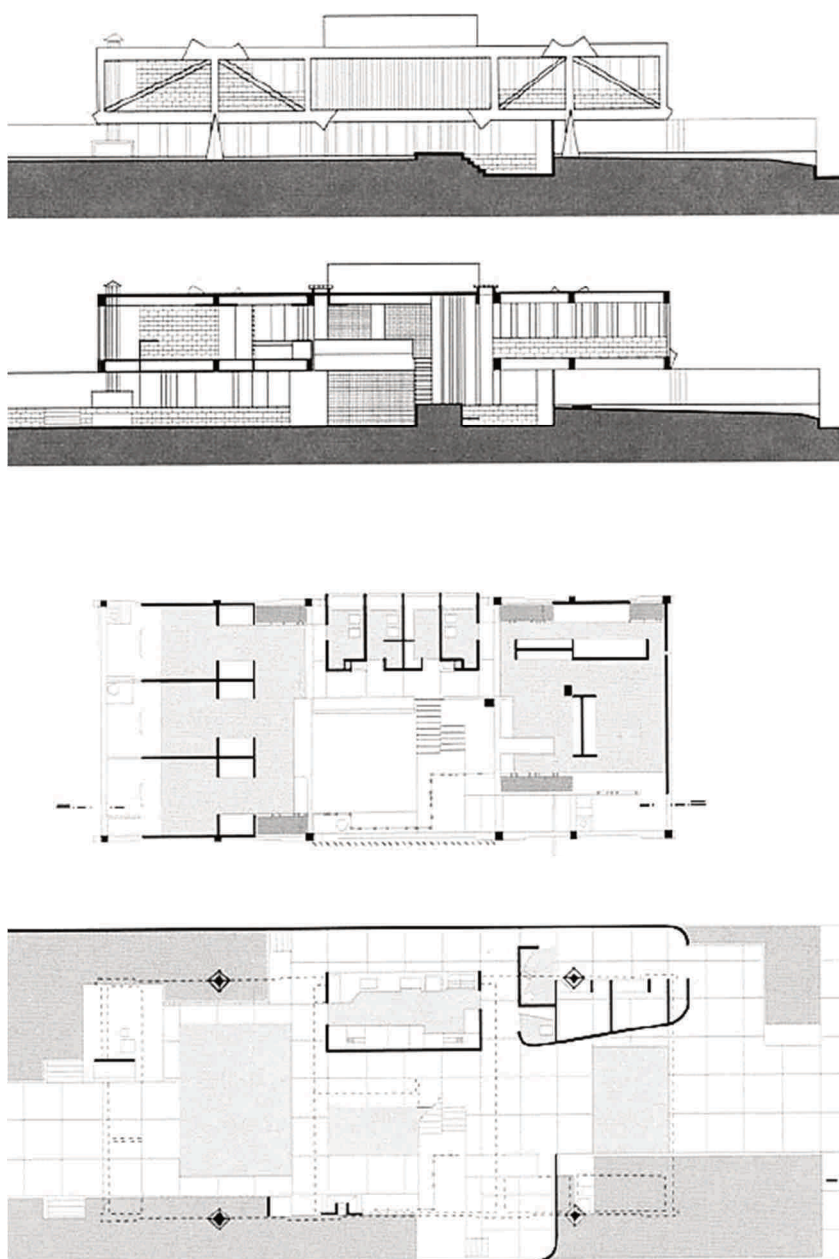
Elevação lateral, secção longitudinal, planta do pavimento superior e planta do pavimento térreo da residência Cleômenes Dias Batista. Como pode ser visto no pavimento térreo, quatro pilares em formato de tronco de pirâmide servem de apoio para o volume superior. O único volume que não se apropria dessa fluidez no térreo é a cozinha, localizada no retângulo central. Fonte: GUIMARÃES, 2006.
